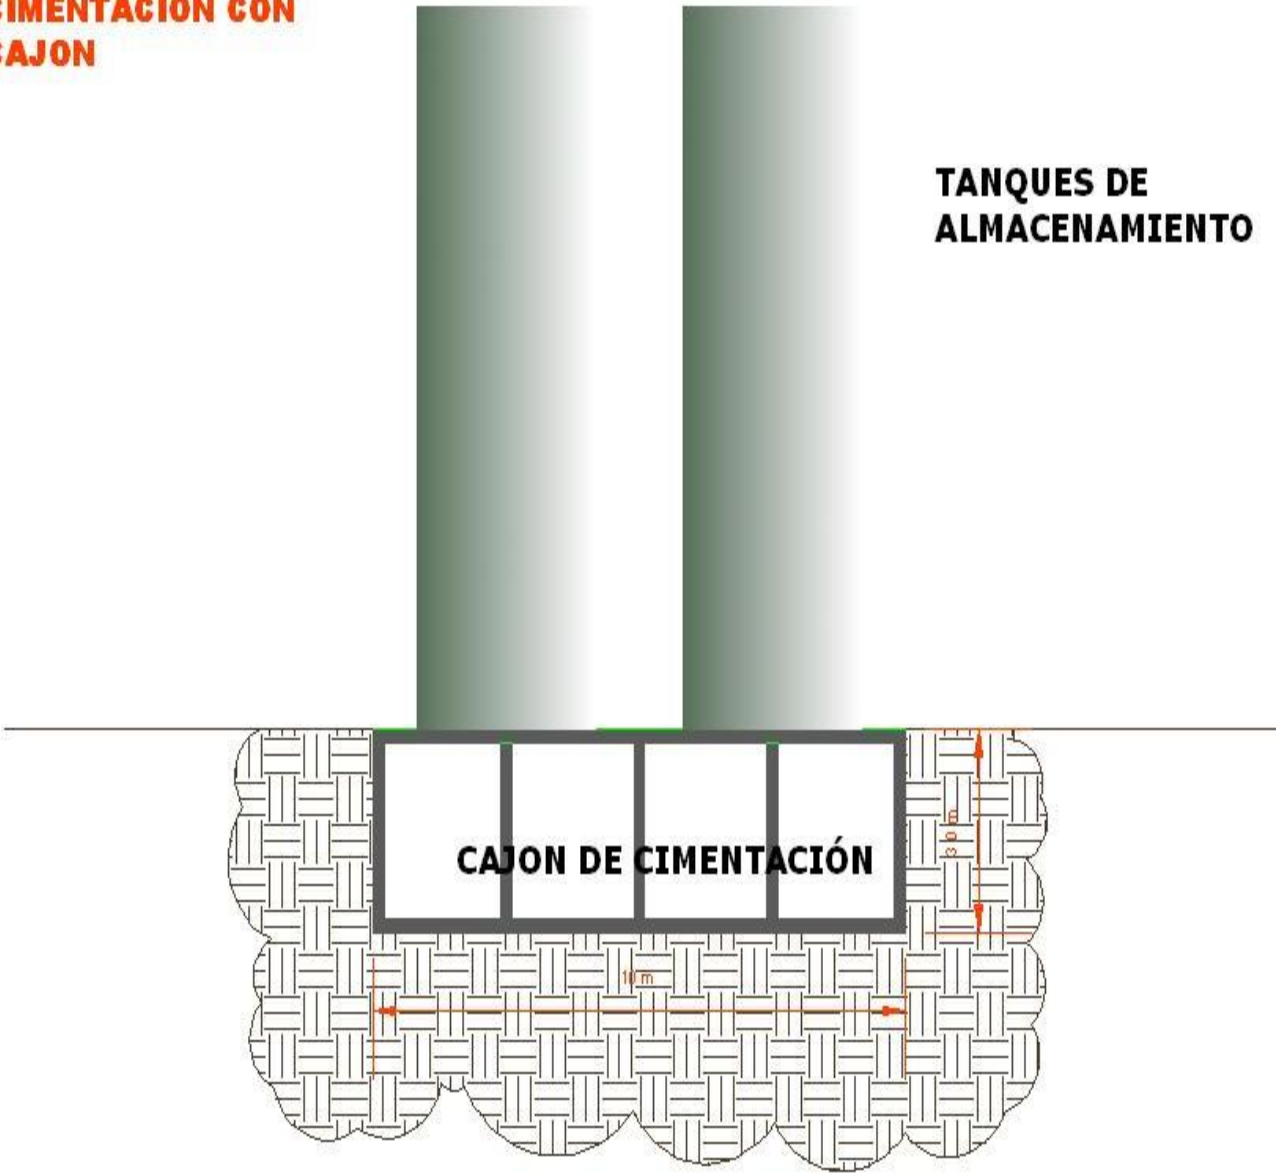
ALTERNATIVA DE CIMENTACION CON CAJÓN.
